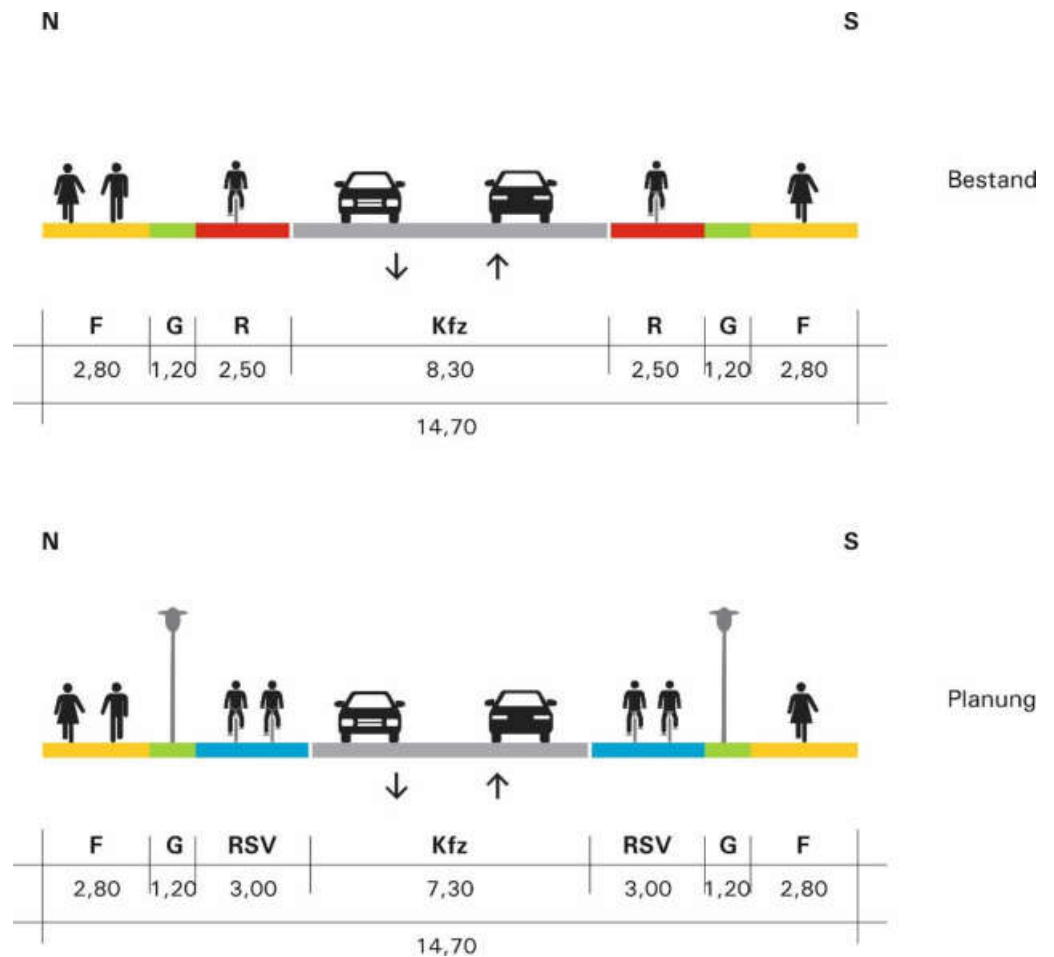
Querschnitt BW-01-a3 (Bundesstraße 1)
